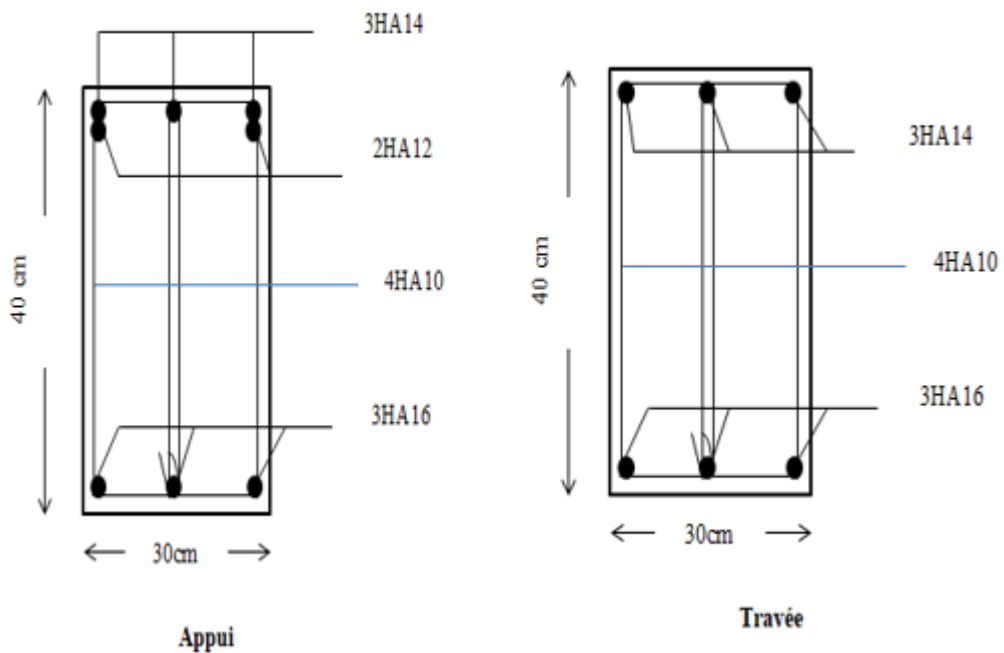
Schéma de ferrailage des poutres non porteuses de l'Étage Technique.
